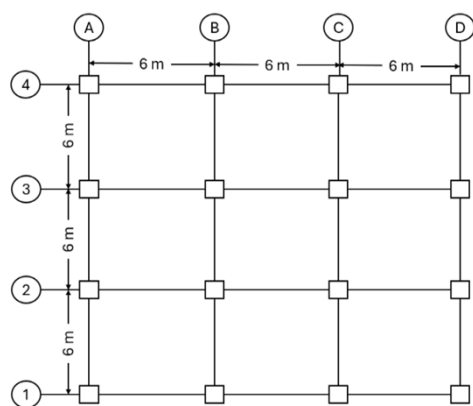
Vista en planta de los edificios con dimensiones variables.
